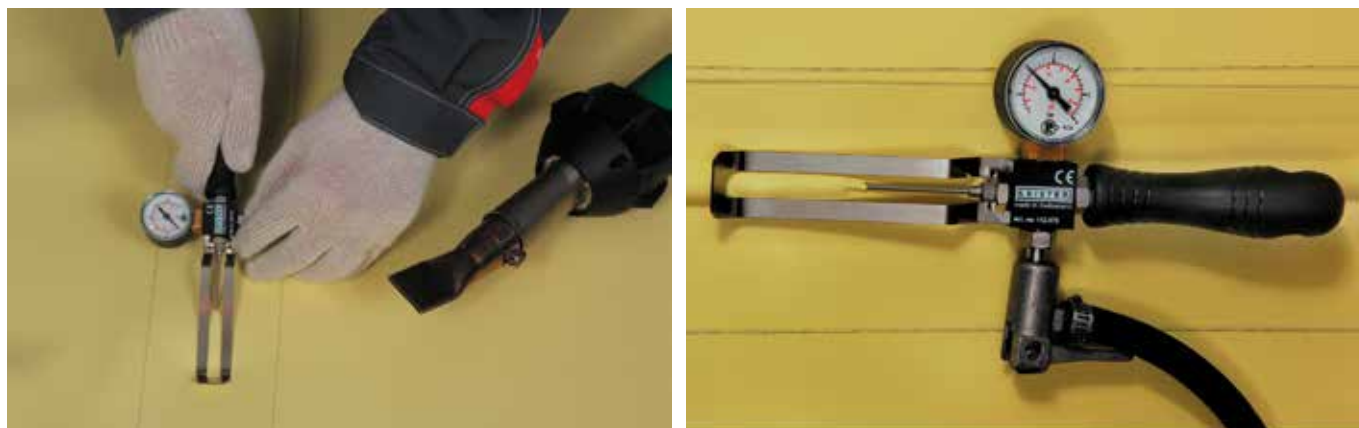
Контроль качества сварного шва с помощью манометра
